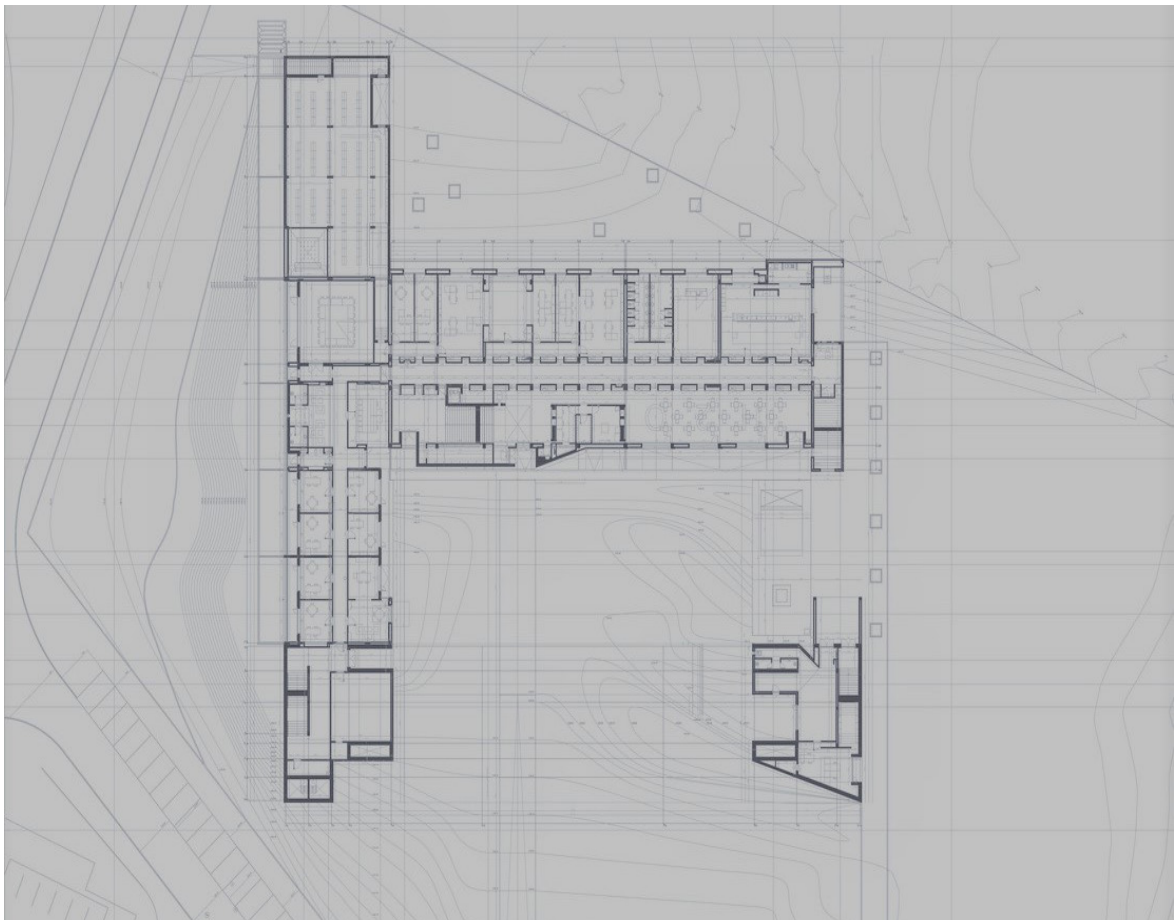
Escola Superior de Gestão e Tecnologia de Beja, planta piso térreo.
